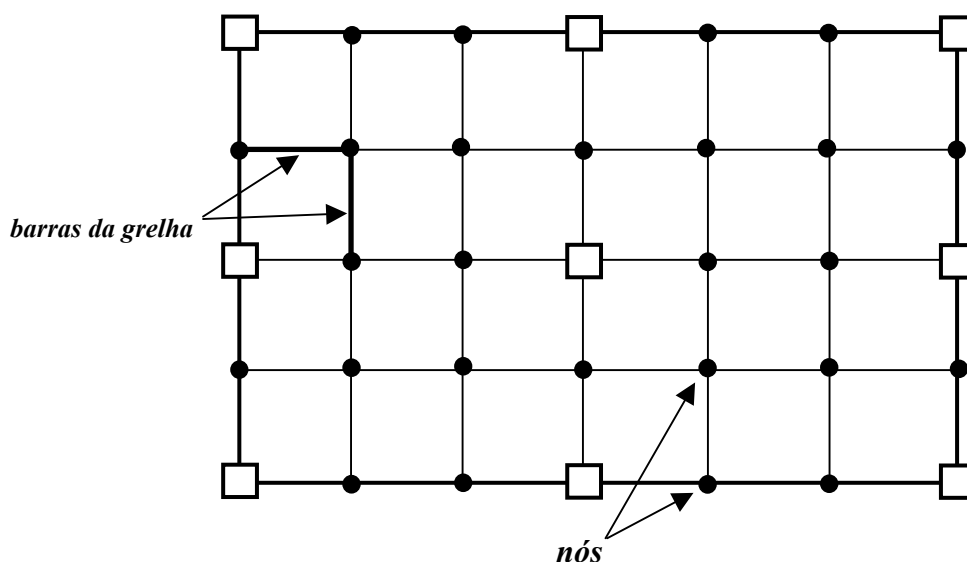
Laje plana discretizada em uma grelha – malha de vigas ortogonais entre si.
